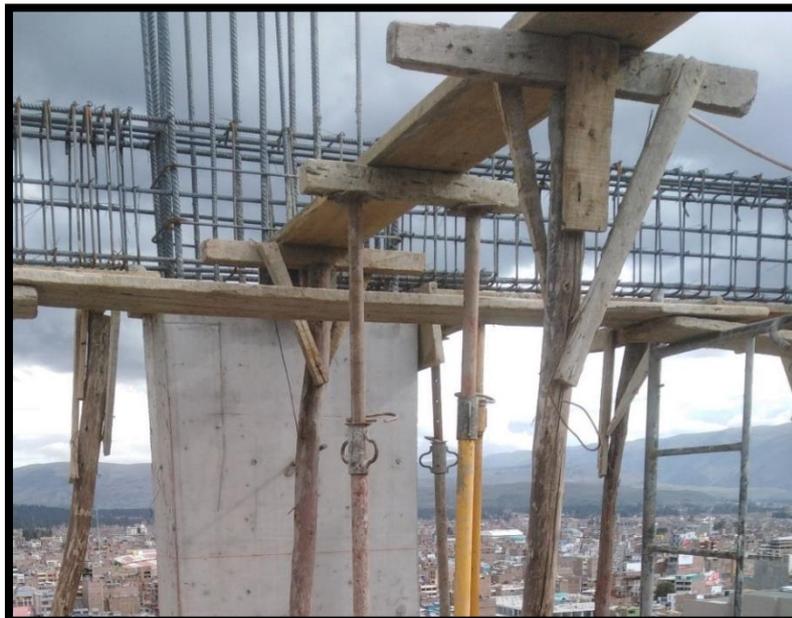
Colocado de los estribos en los nodos (columna y viga)
